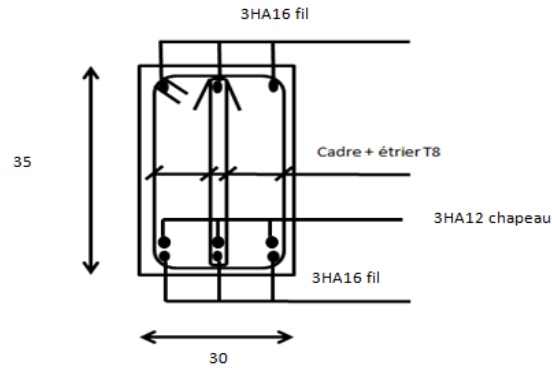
Ferrailage en travée d'une poutre secondaire loin des voiles.✓ Sur appuis :
